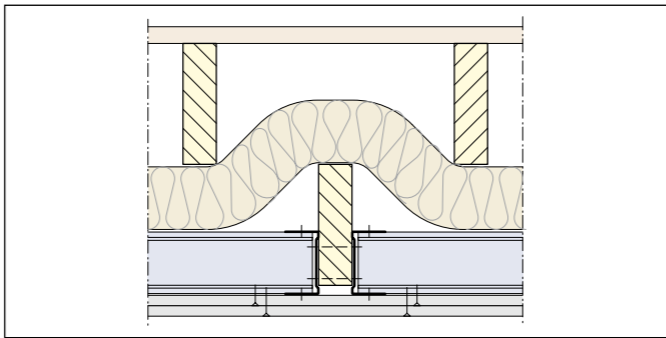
Gyproc voorzetwand - woningscheidende wand - Gyproc voorzetwand - gevelconstructie
